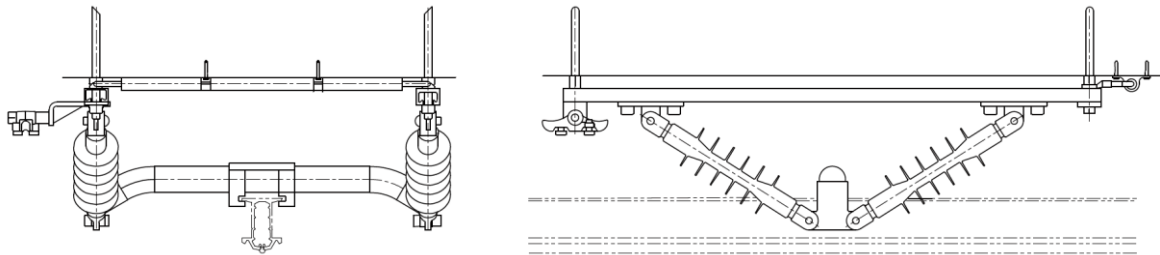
Darstellung Tragwerk Deckenstromschiene, System Malvie (Quelle: Furrer + Frey)
